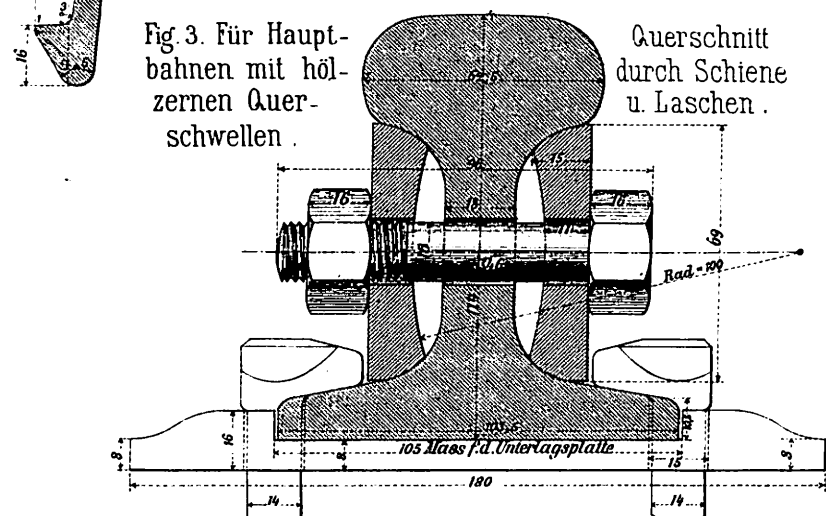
Für Hauptbahnen mit hölzernen Querschwellen.
